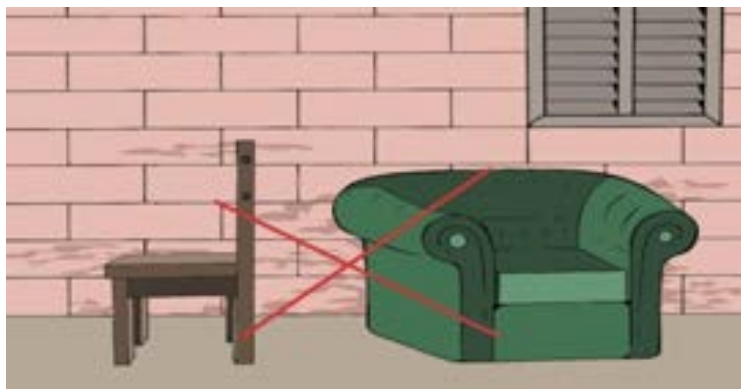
Fauteuil et chaise placés contre le mur en ML laissant des traces
